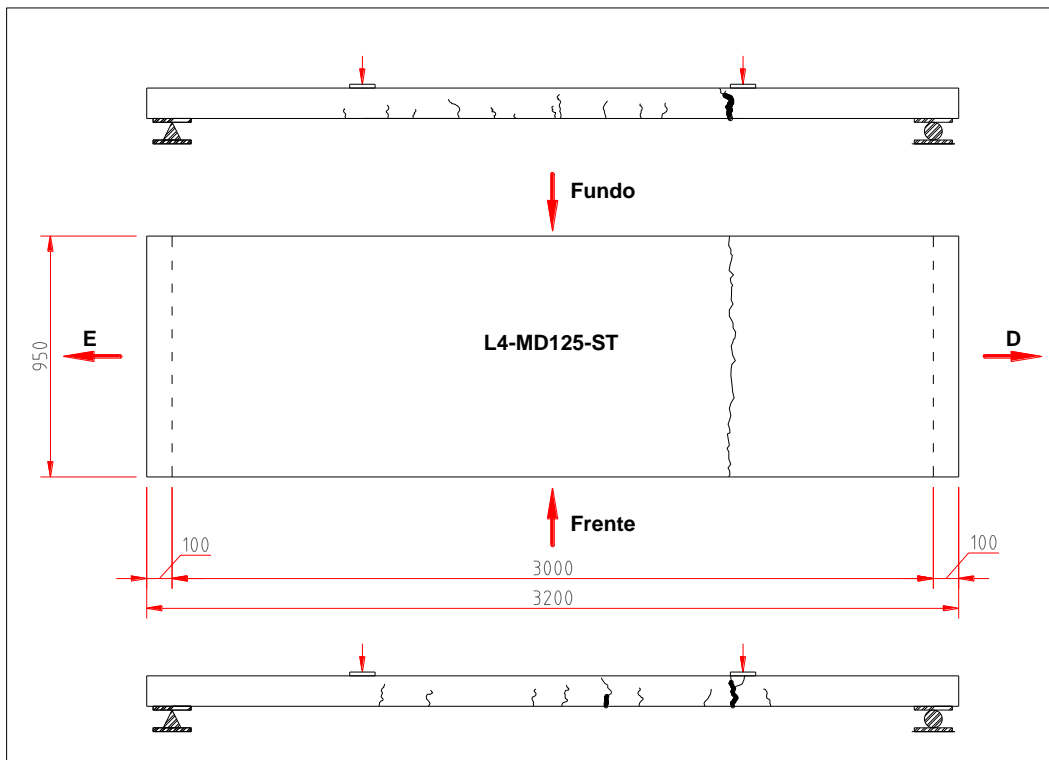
Fissuras da Laje Mista L4-MD125-ST após ensaio de flexão a quatro pontos
